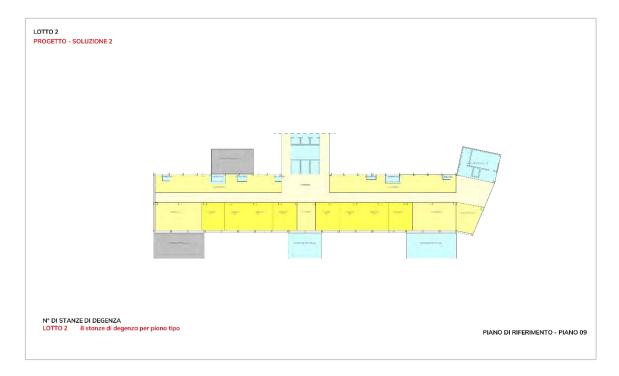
PROGETTO PIANO TIPO LOTTO 2 - SOLUZIONE 2
